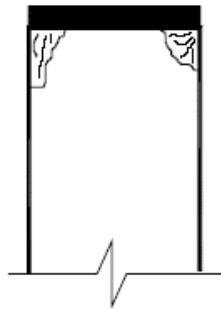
Fissuras e/ou Trincas em Dentes de Articulação: Dependendo da gravidade, há riscos de ruptura frágil
